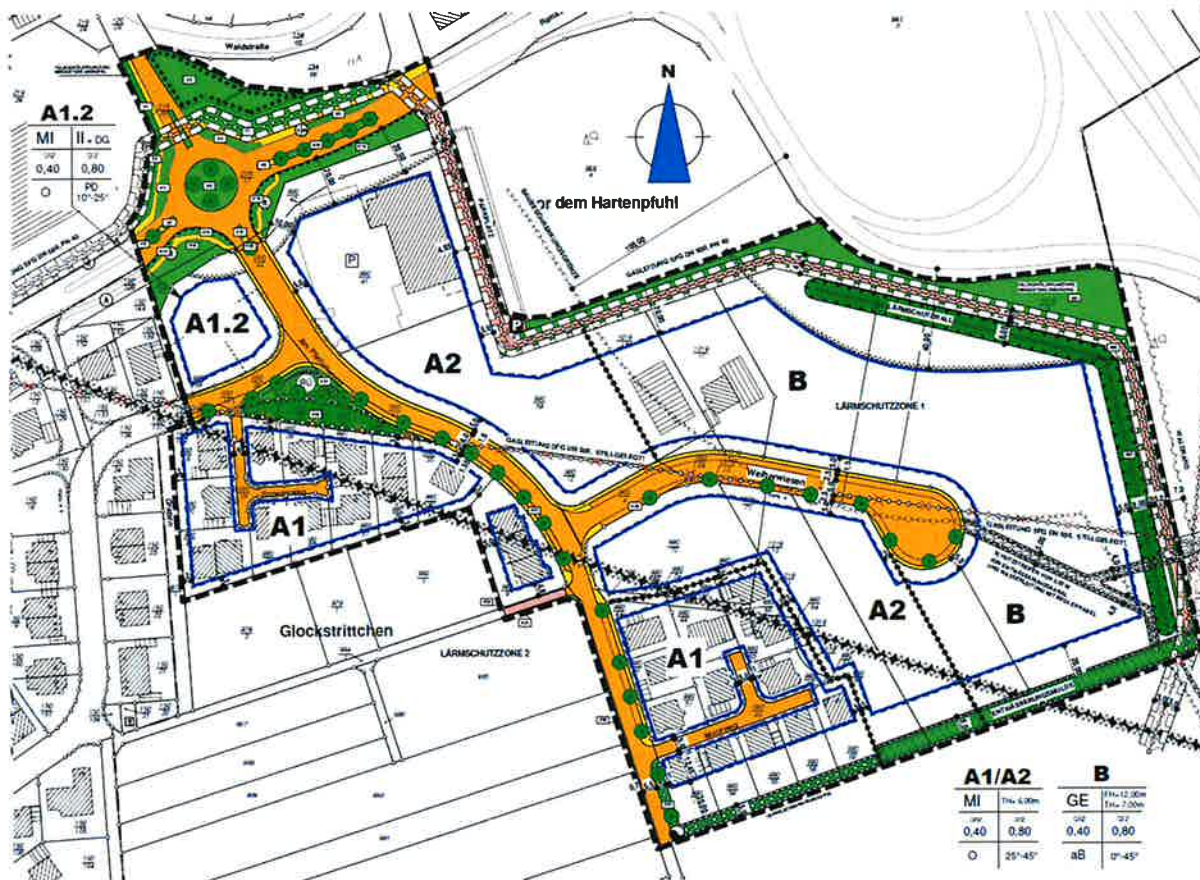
Auszug Bebauungsplan "Dienstleistungs- und Handwerkerpark", Änderung 3
